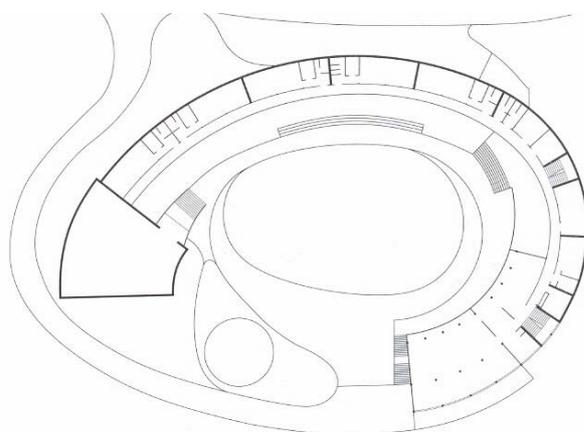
y 13. Vista desde el mar y plano de planta del Albergue de Juventud.
